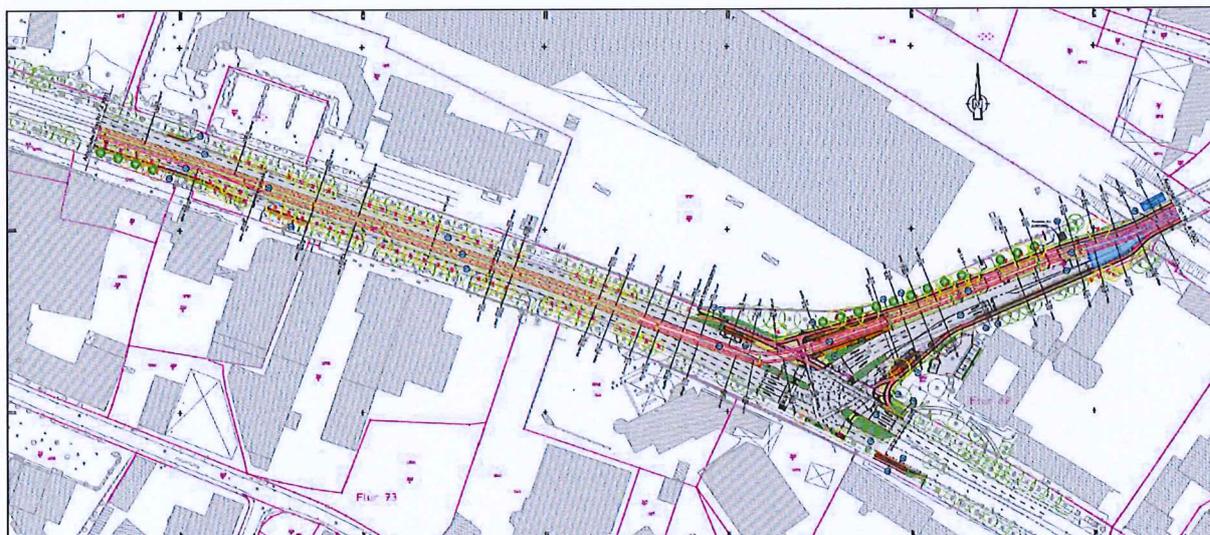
Lageplan Vorzugsvariante Stresemannstraße Anschluss Steubenstraße
